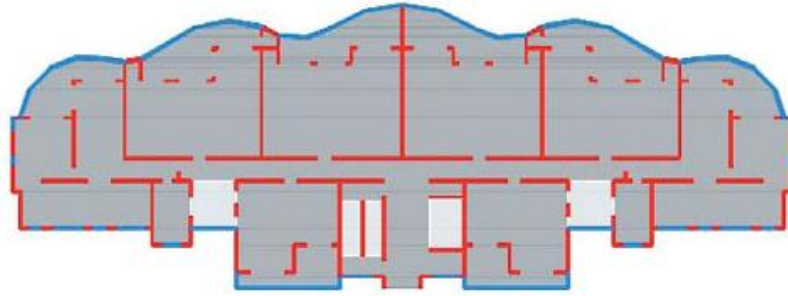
Planta típica del edificio *Bosquemar*, Concepción. (Rojo = muros – Azul = vigas). Youssef et. al., 2011.
